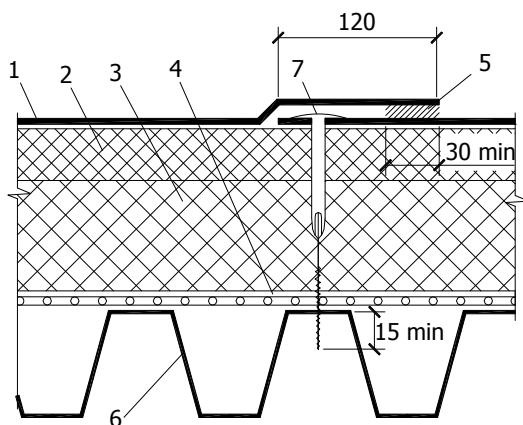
Схема крепления ПВХ-мембран и утеплителя к несущей конструкции из стального профилированного настила:
